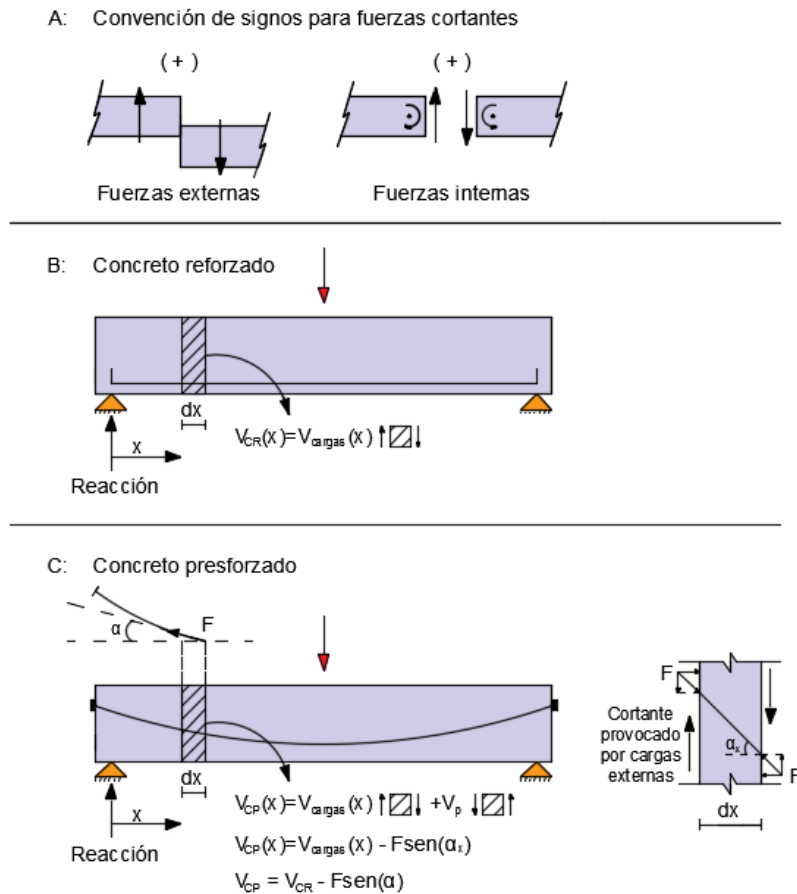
Fuerza cortante en concreto reforzado y presfuerzo
